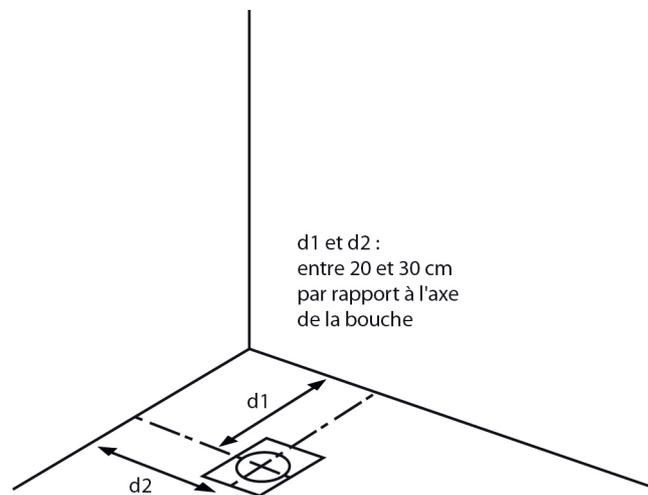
4 : Exemple d'installation d'une bouche de soufflage au sol
